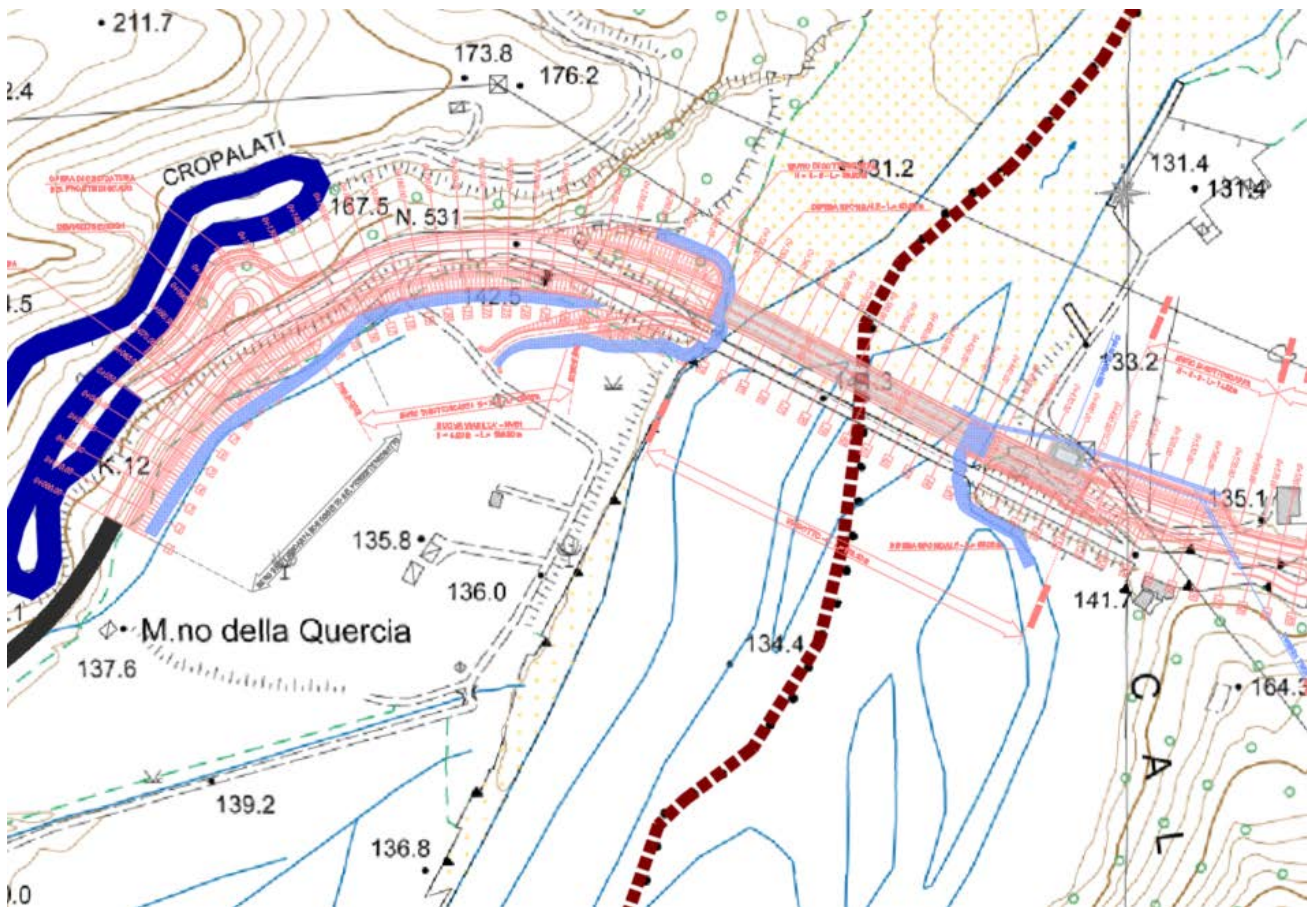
Da spalla riva dx ponte Trionto a fine progetto
